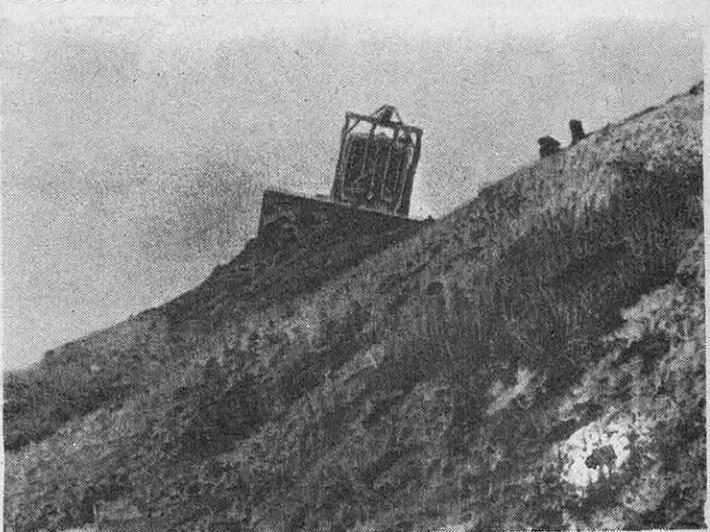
CONSTRUCTION D'UNE ROUTE A FLANC DE COTEAU
